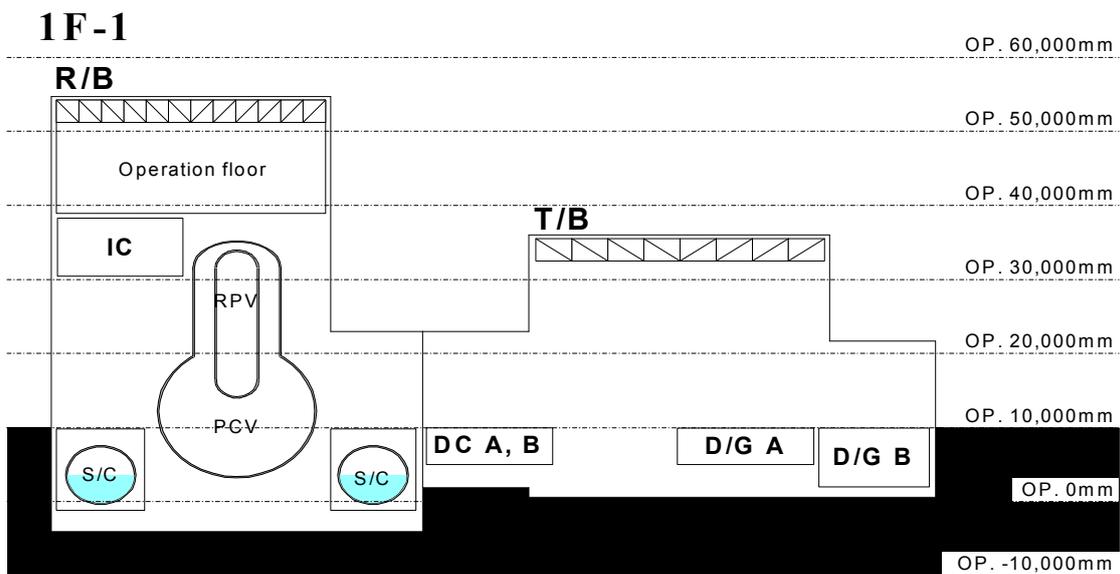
福島第一原子力発電所 1号機 建屋断面図
